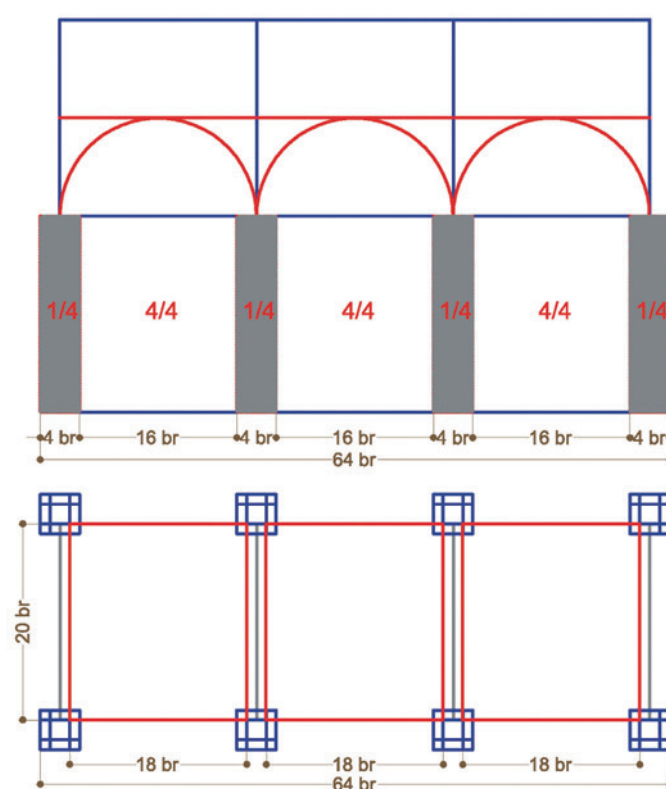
Schéma 3 du plan et de la façade de la Loggia
